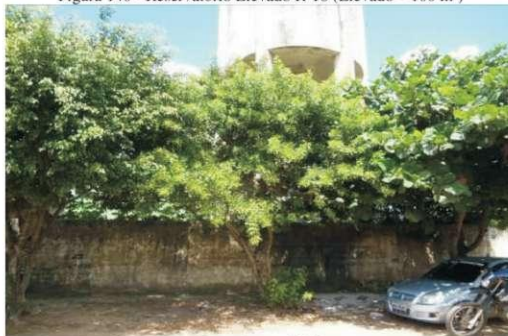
Reservatório Elevado R-16 (Elevado – 100 m³)
